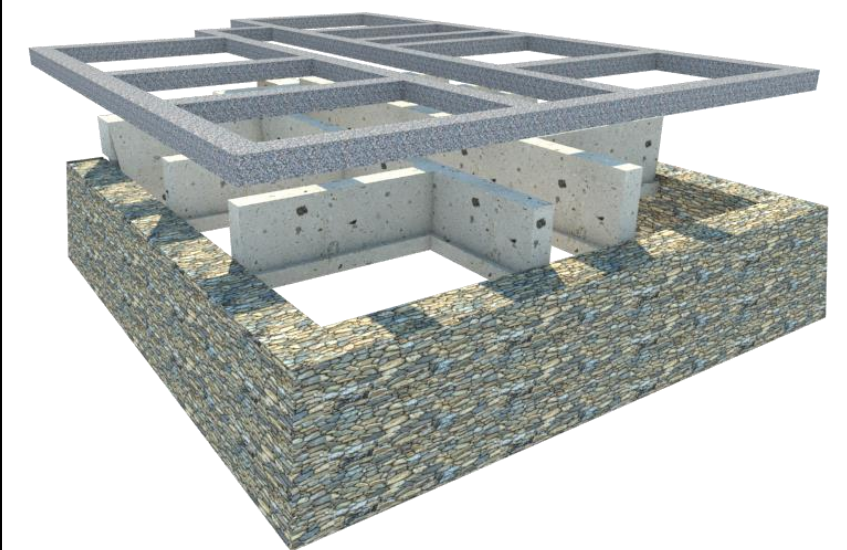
Modelado en 3D de fundaciones y detalle de cimentación de vivienda TIKVA.
